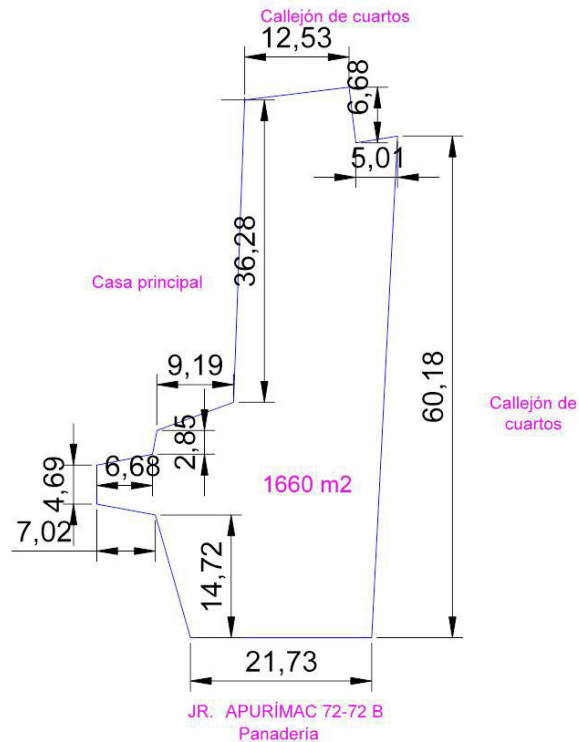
Linderos de la panadería propiedad de la Testamentaria Gálvez.
